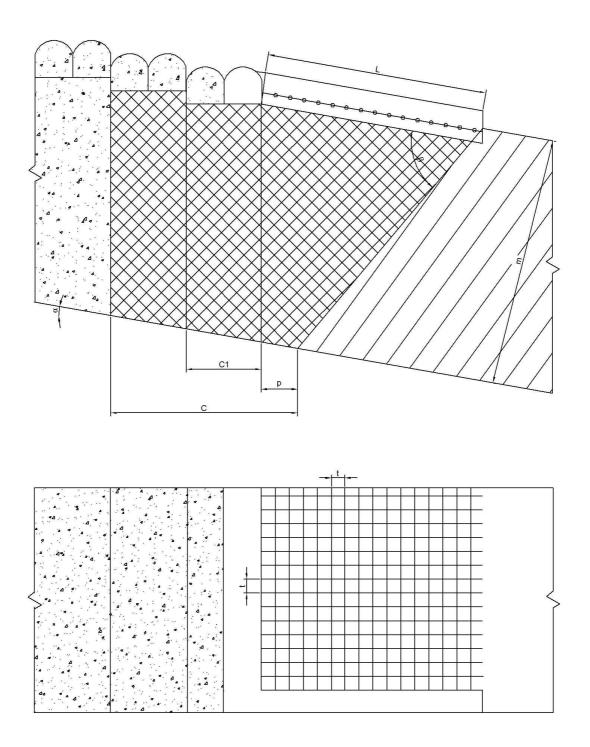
Схема формирования защищенной зоны бурением перекрещивающихся скважин по кровле рудного тела из выработок защитного слоя
